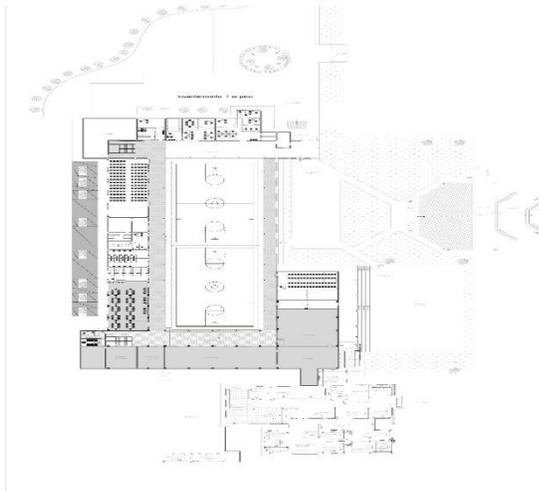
Planos de la planta física de la Institución. Primer piso.
